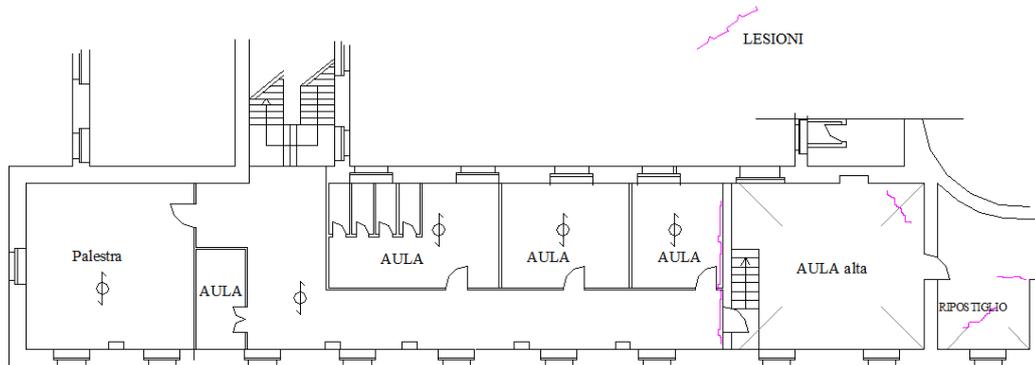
Rilievo quadro fessurativo secondo piano (Allegato 6)
